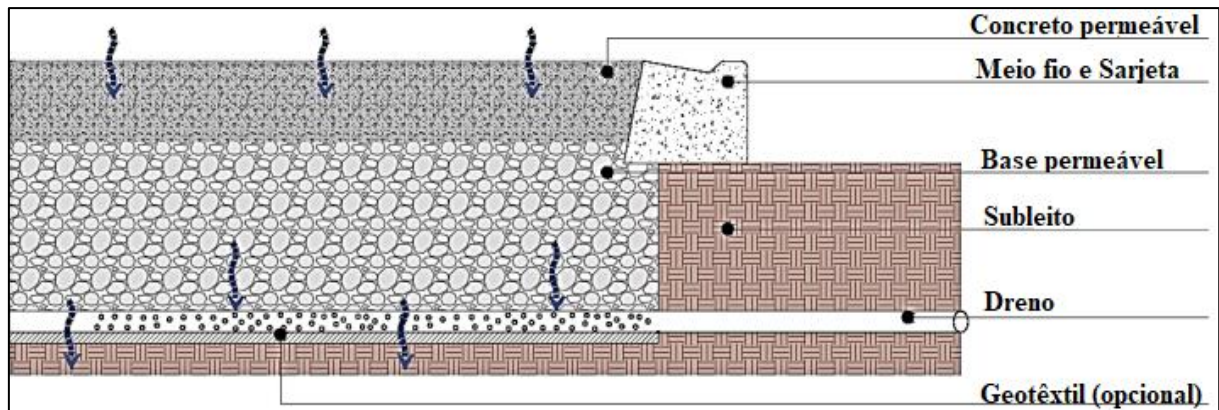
Projeto de Pavimento de Concreto Permeável com Infiltração Total
